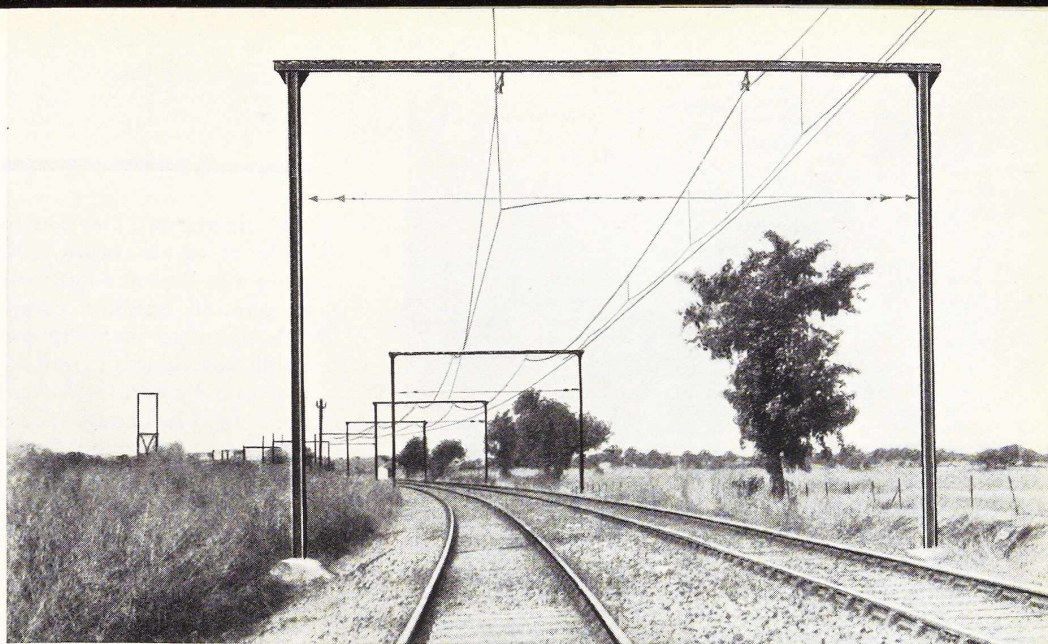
Portiques en poutrelles à larges ailes supportant la ligne du Great Indian Peninsular Railway (Indes anglaises).
